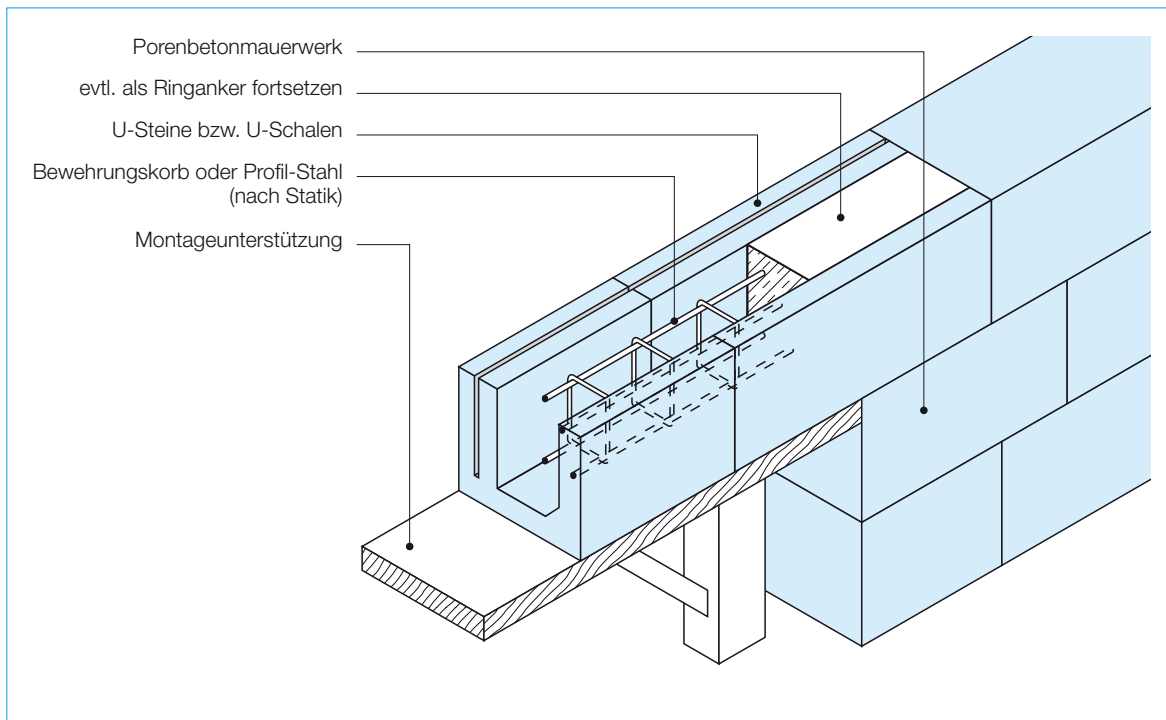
Sturzausbildung mit Porenbeton-U-Steinen bzw. Porenbeton-U-Schalen
